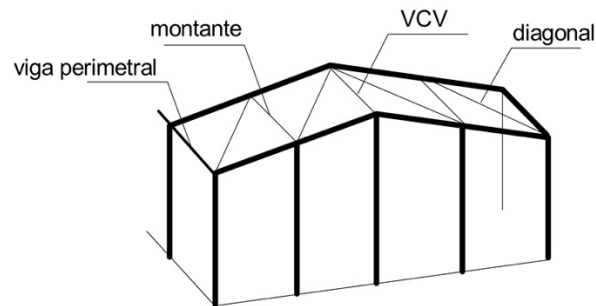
Disposición arriostramiento de cubierta. Tecnología de la Construcción.
